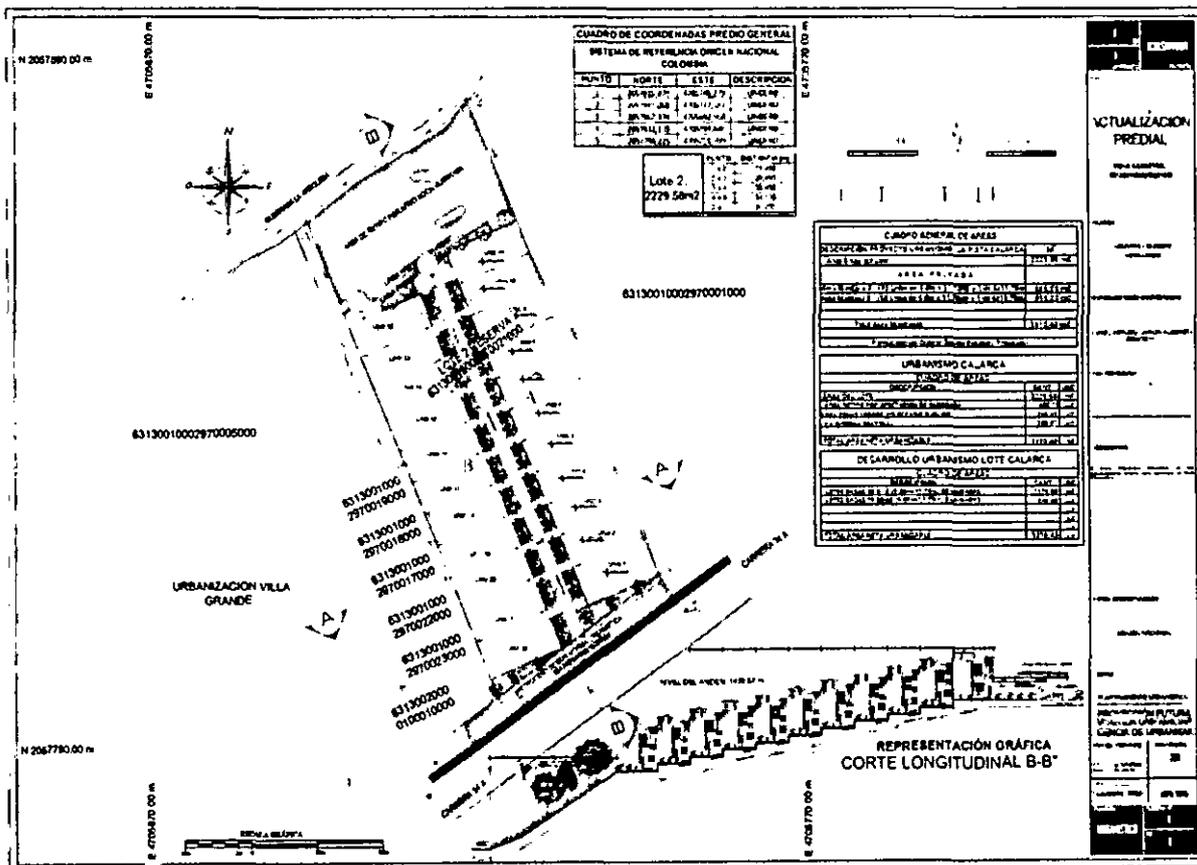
Plano del proyecto de construcción Proyección Futura Vivienda Unifamiliar Licencia de Urbanismo. Fuente: Solicitante, 2025
